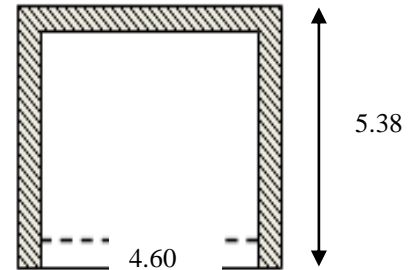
Dimensions du panneau de dalle le plus sollicité
